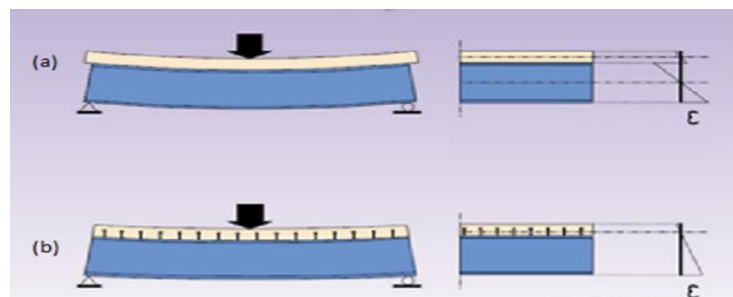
(a) Poutre non mixte, (b) : et poutre mixte [1]
